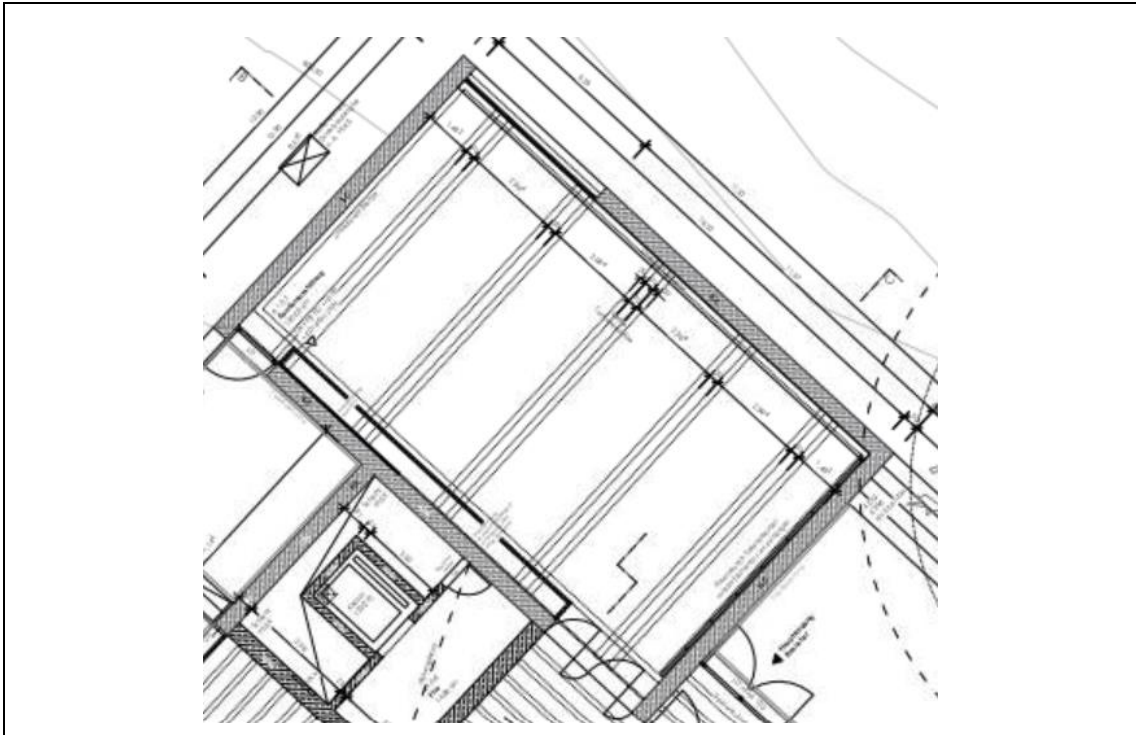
Grundriss Entwurfsplanung Sonderausstellung, Meck Architekten [27]
